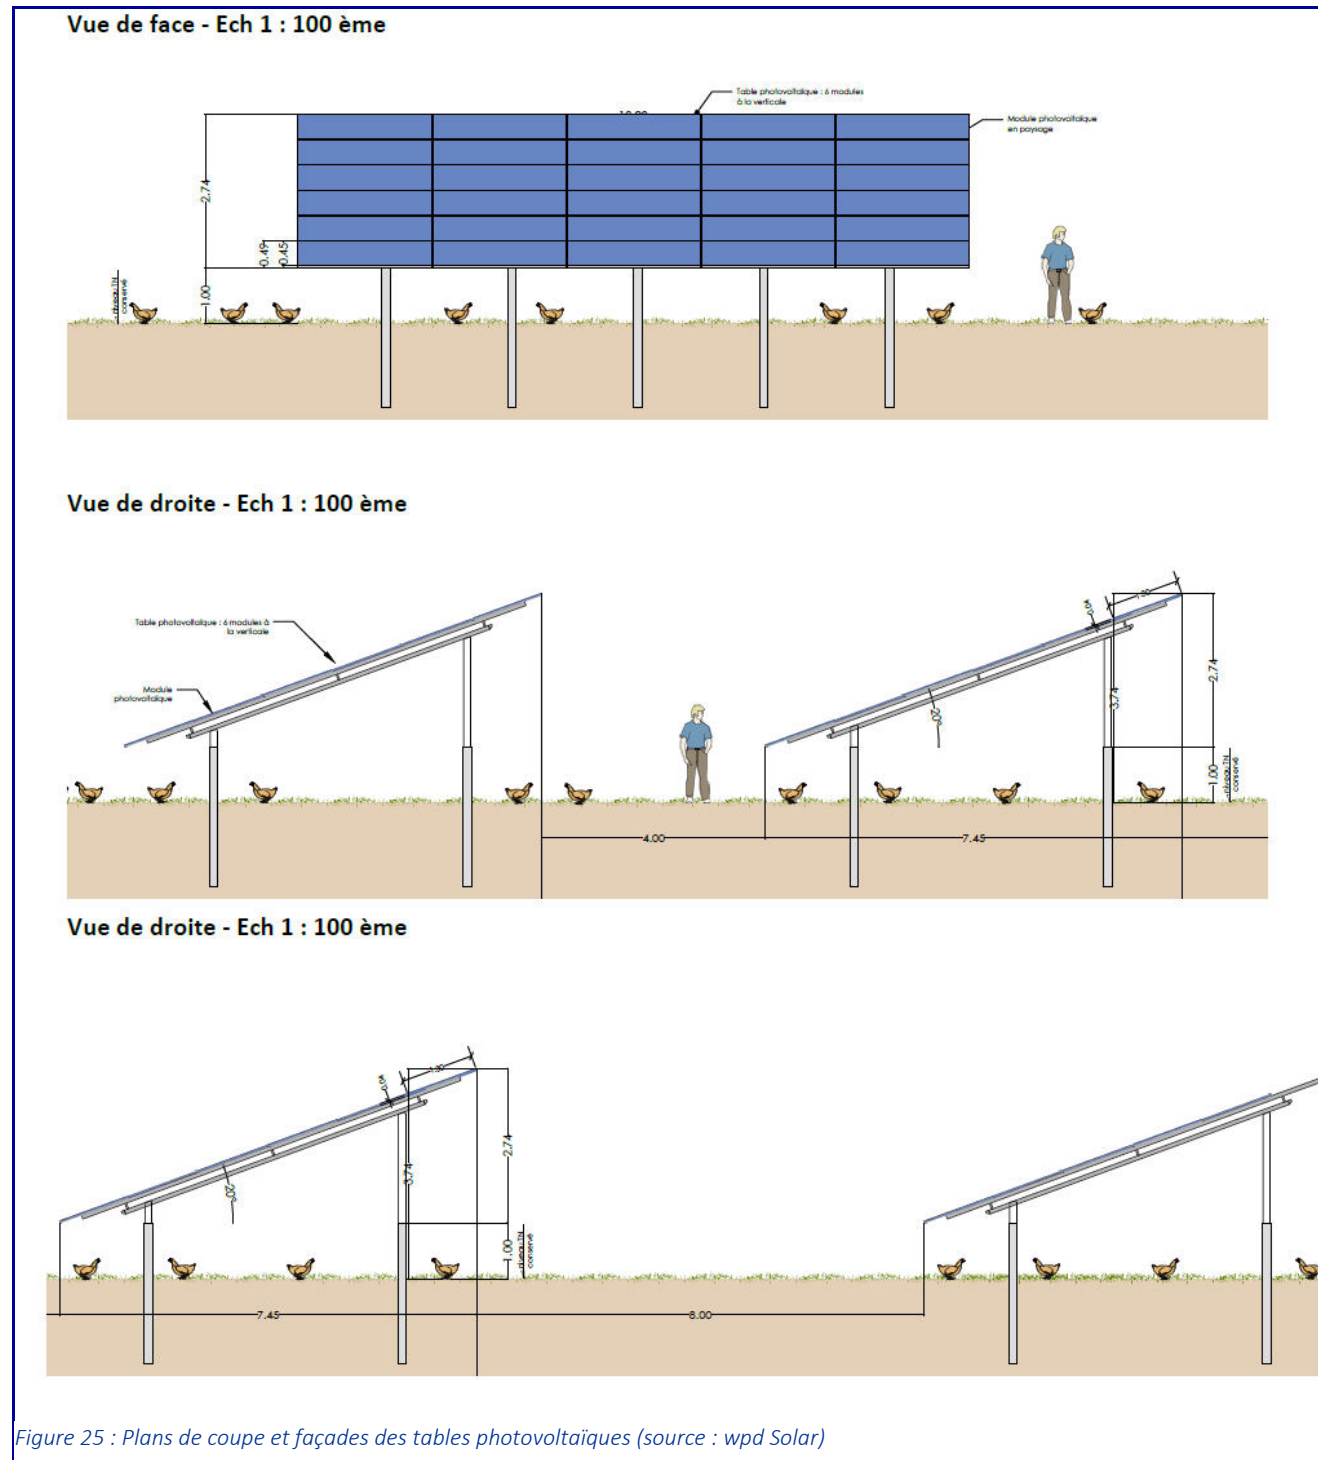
Plans de coupe et façades des tables photovoltaïques (source : wpd Solar)
